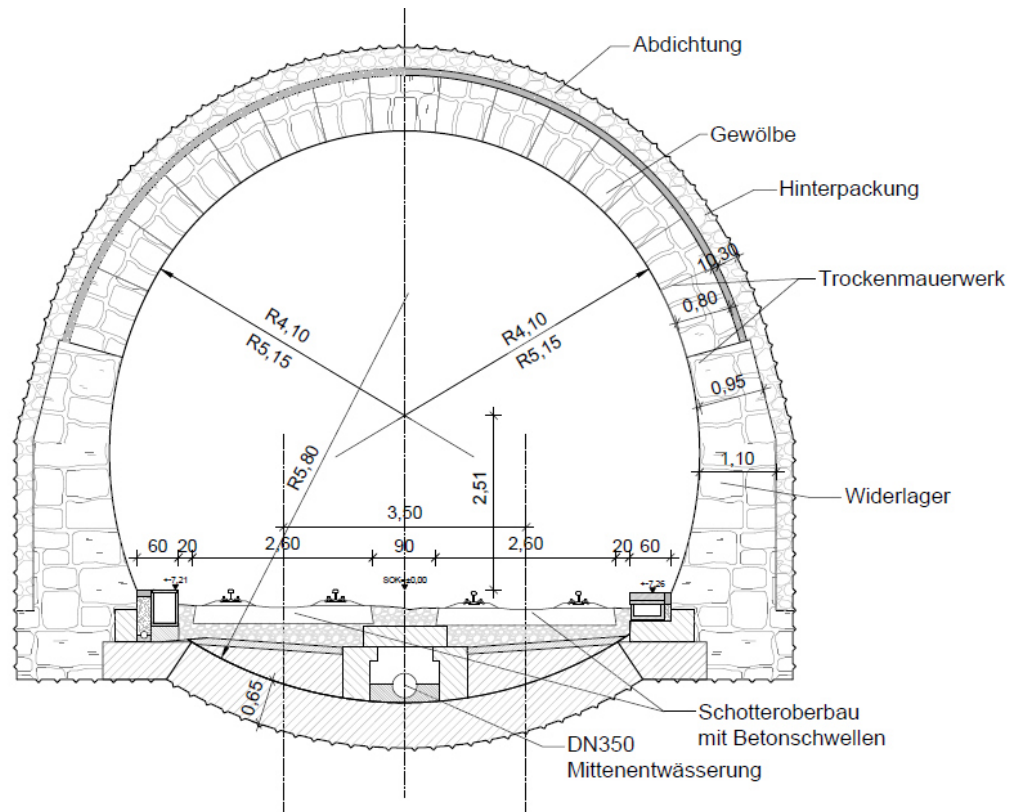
Tunnelprofil (mittleres Druckprofil) des Modelltunnels.
